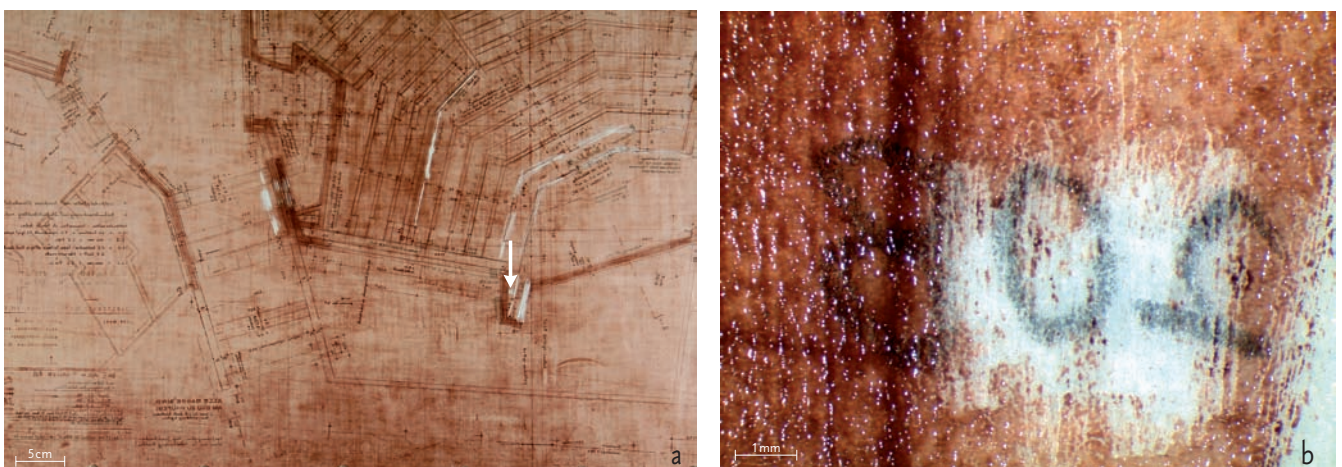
Marl/Westfalen, Westfalenstraße, Haupt- und Grundschule Marl-Drewer Süd (1960–71), Hans-Scharoun-Archiv WV 214/o. S., Grundriss, 98 × 132 cm, Ausschnitt (a) und Detail (b). Der Pfeil in Abb. 6a markiert die Position der Detailaufnahme in Abb. 6b. Diazotypie auf Transparentpapier mit einseitiger, glänzender Oberflächenbeschichtung, mechanischer Korrektur und Überarbeitungen. Auf der sensibilisierten Rückseite wurde die Beschichtung stellenweise von der Oberfläche abgekratzt, um die darin eingebetteten Bildlinien zu entfernen (a). Darunter wird ein hellblau eingefärbter Papierträger sichtbar. An diesen Stellen wurden Überarbeitungen mit Bleistift vorgenommen, die, da auf der unbeschichteten Vorderseite ausgeführt, hier seitenverkehrt erscheinen (b).
